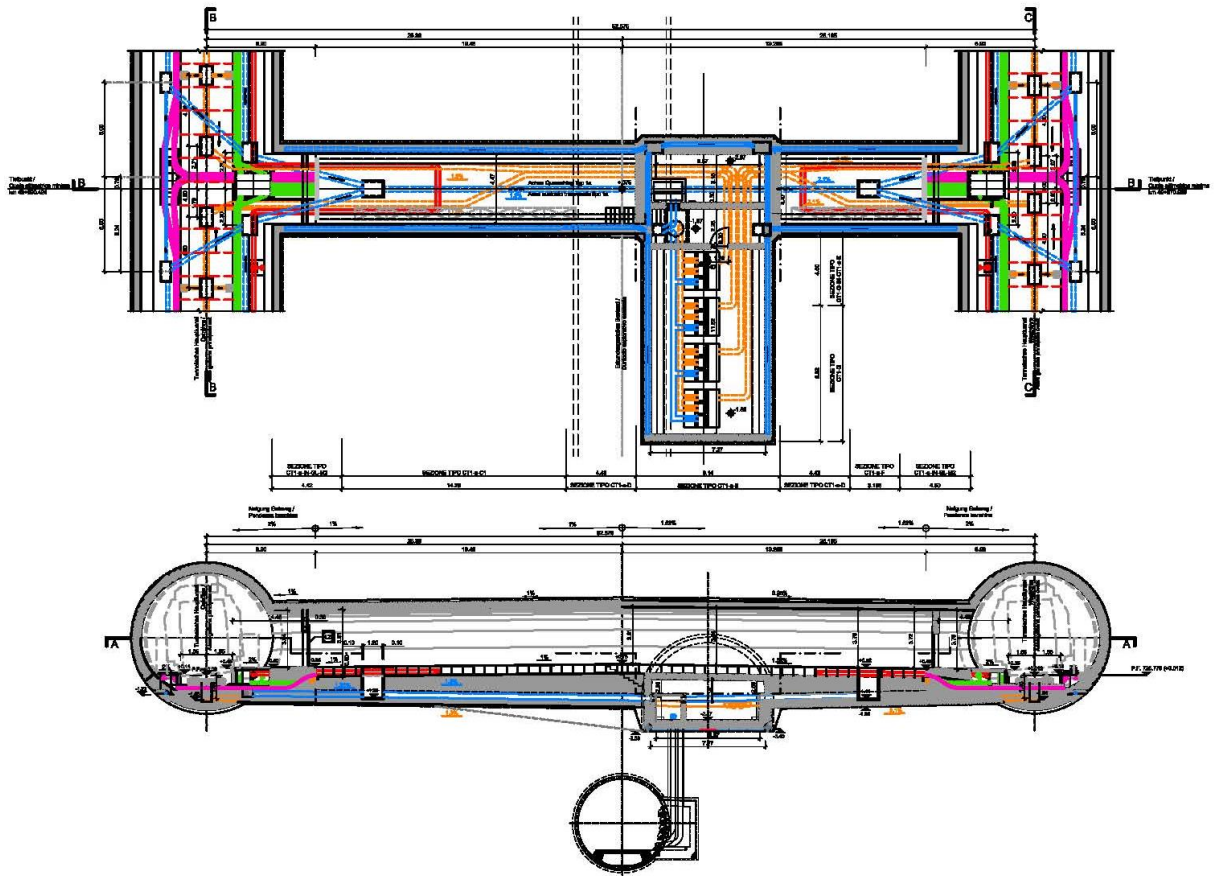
Schnitt und Grundriss BP 49/2
